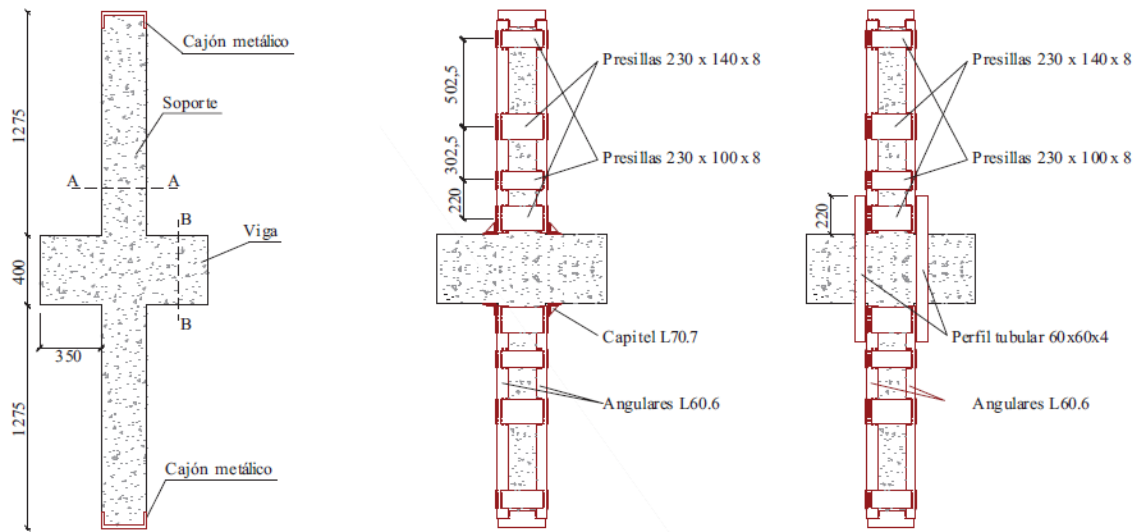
Probetas ensayadas por Adam (2007), Adam et al. (2008a; 2008b). a) geometría, b) refuerzo probetas AxL.C, c) refuerzo probetas AxL.T. (Cotas en mm.) (adaptada de Garzón-Roca 2013)
